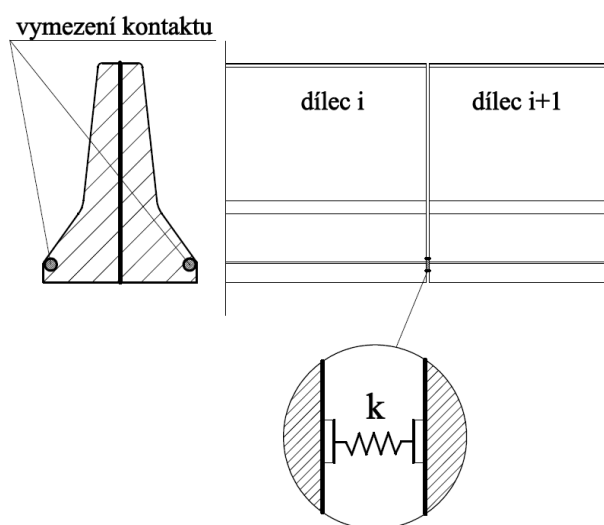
Model kontaktu pomocí „nelineární pružiny“
